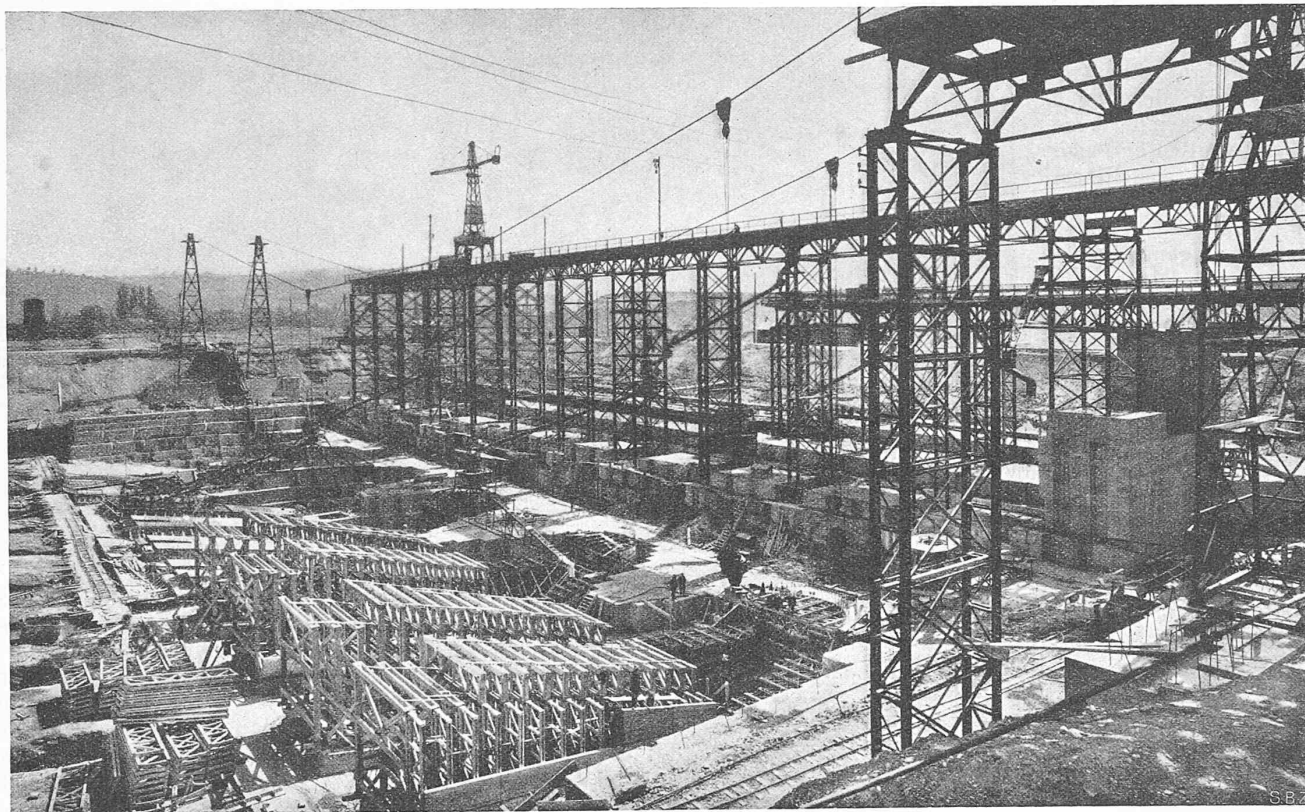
Gussbeton-Anlage mit festen Stegen und fahrbarem Kabelkran auf der Maschinenhaus-Baustelle. — Bauzustand 17. Mai 1930.
